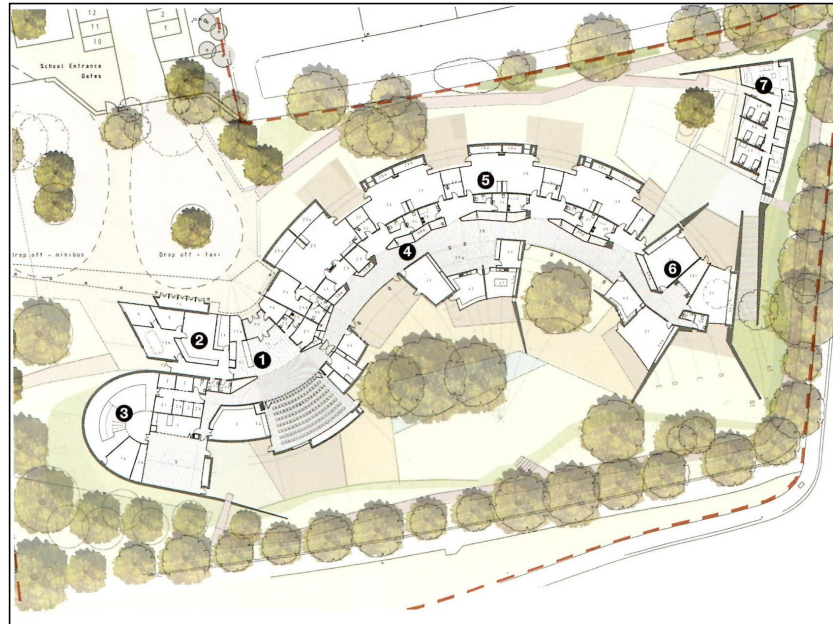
plan détaillé de la Hazelwood School (source : Alan Dunlop architects ;Hazelwood-Sketchbook.pdf)
